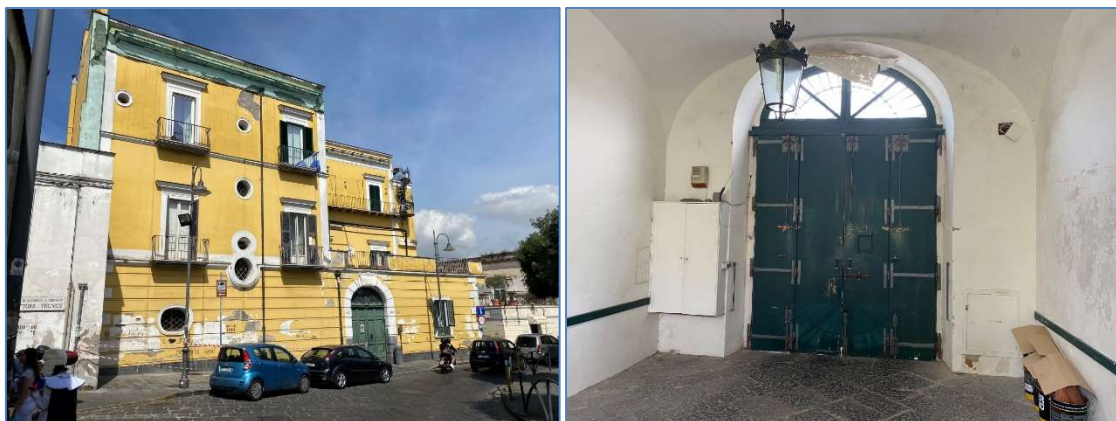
Prospetto est edificio su via Cavalli di Bronzo e androne comune d'ingresso.
